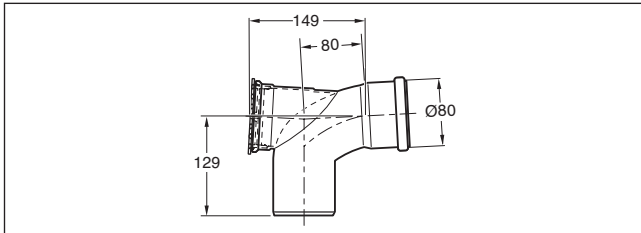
Bogen mit Prüföffnung lang (Maße in mm)
